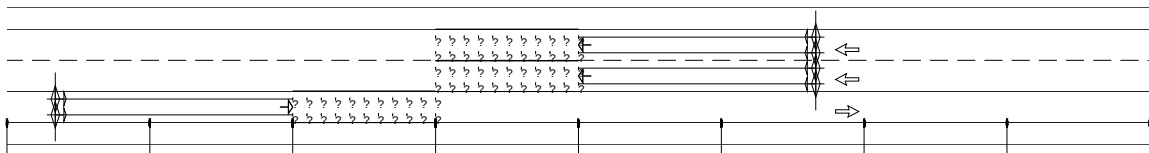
Grilles de calcul pour tronçon droit avec lampadaire et configuration constante
